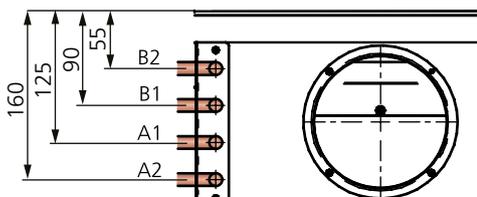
ADAPT Parasol EX 690, Seitenansicht
